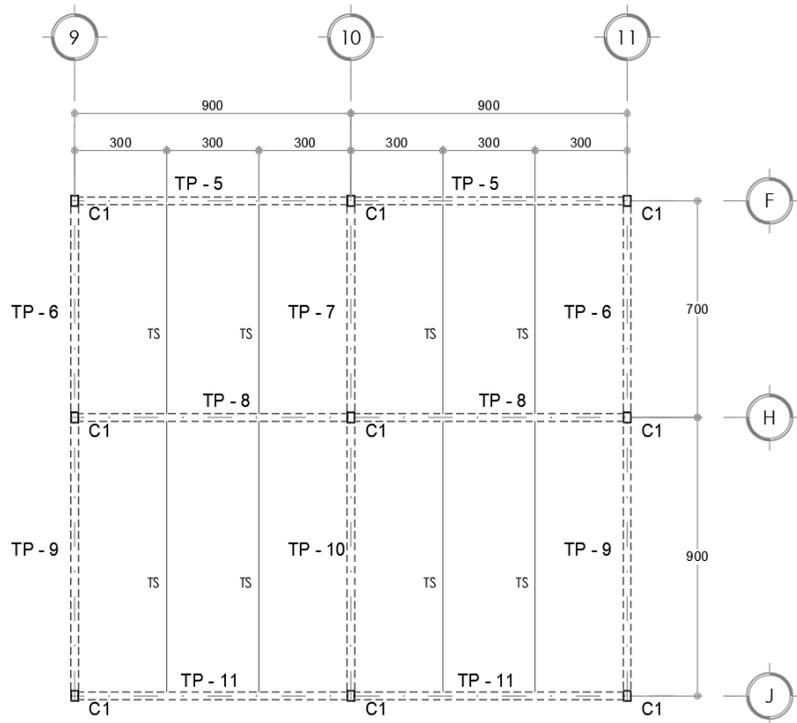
Ubicación de columnas y trabes del edificio B, entre ejes F-J y 9-11
